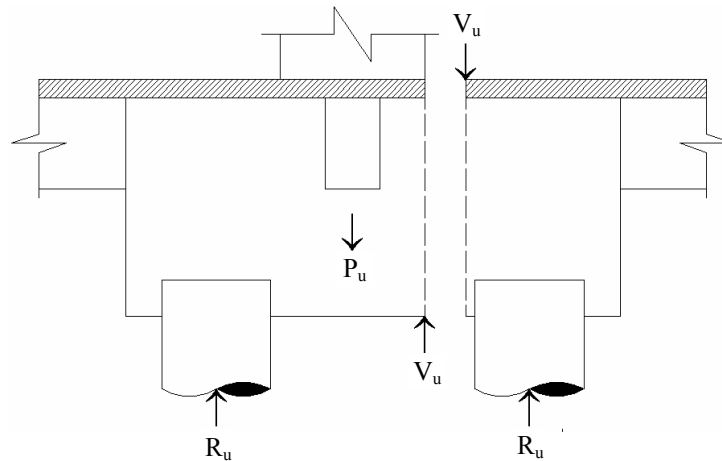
Corte último y sección crítica del cabezal sobre dos pilotes⁹
